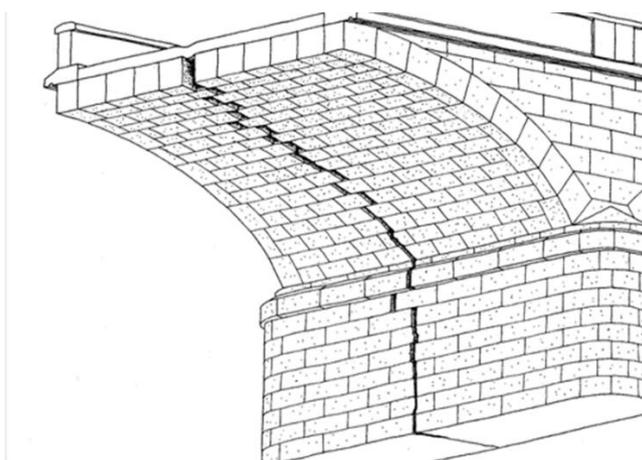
FIS-03 Descripción: Fisuración o agrietamiento longitudinal en franja central de apoyos y bóveda.
